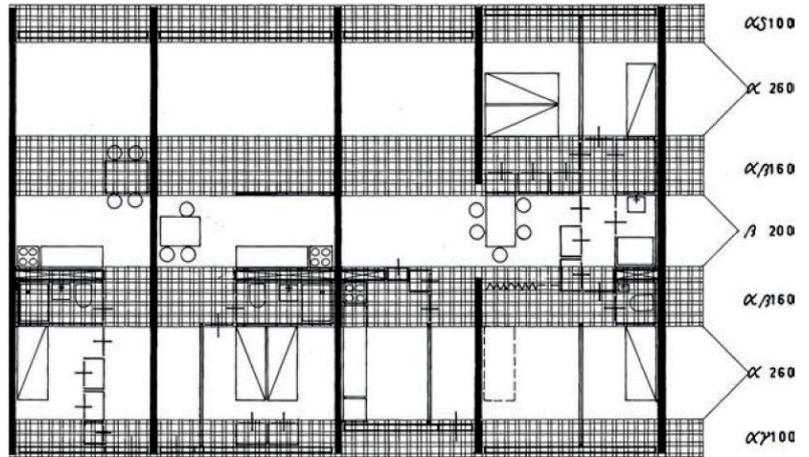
Planta libre con siete franjas paralelas a las fachadas. Fuente: Montaner (2015)
